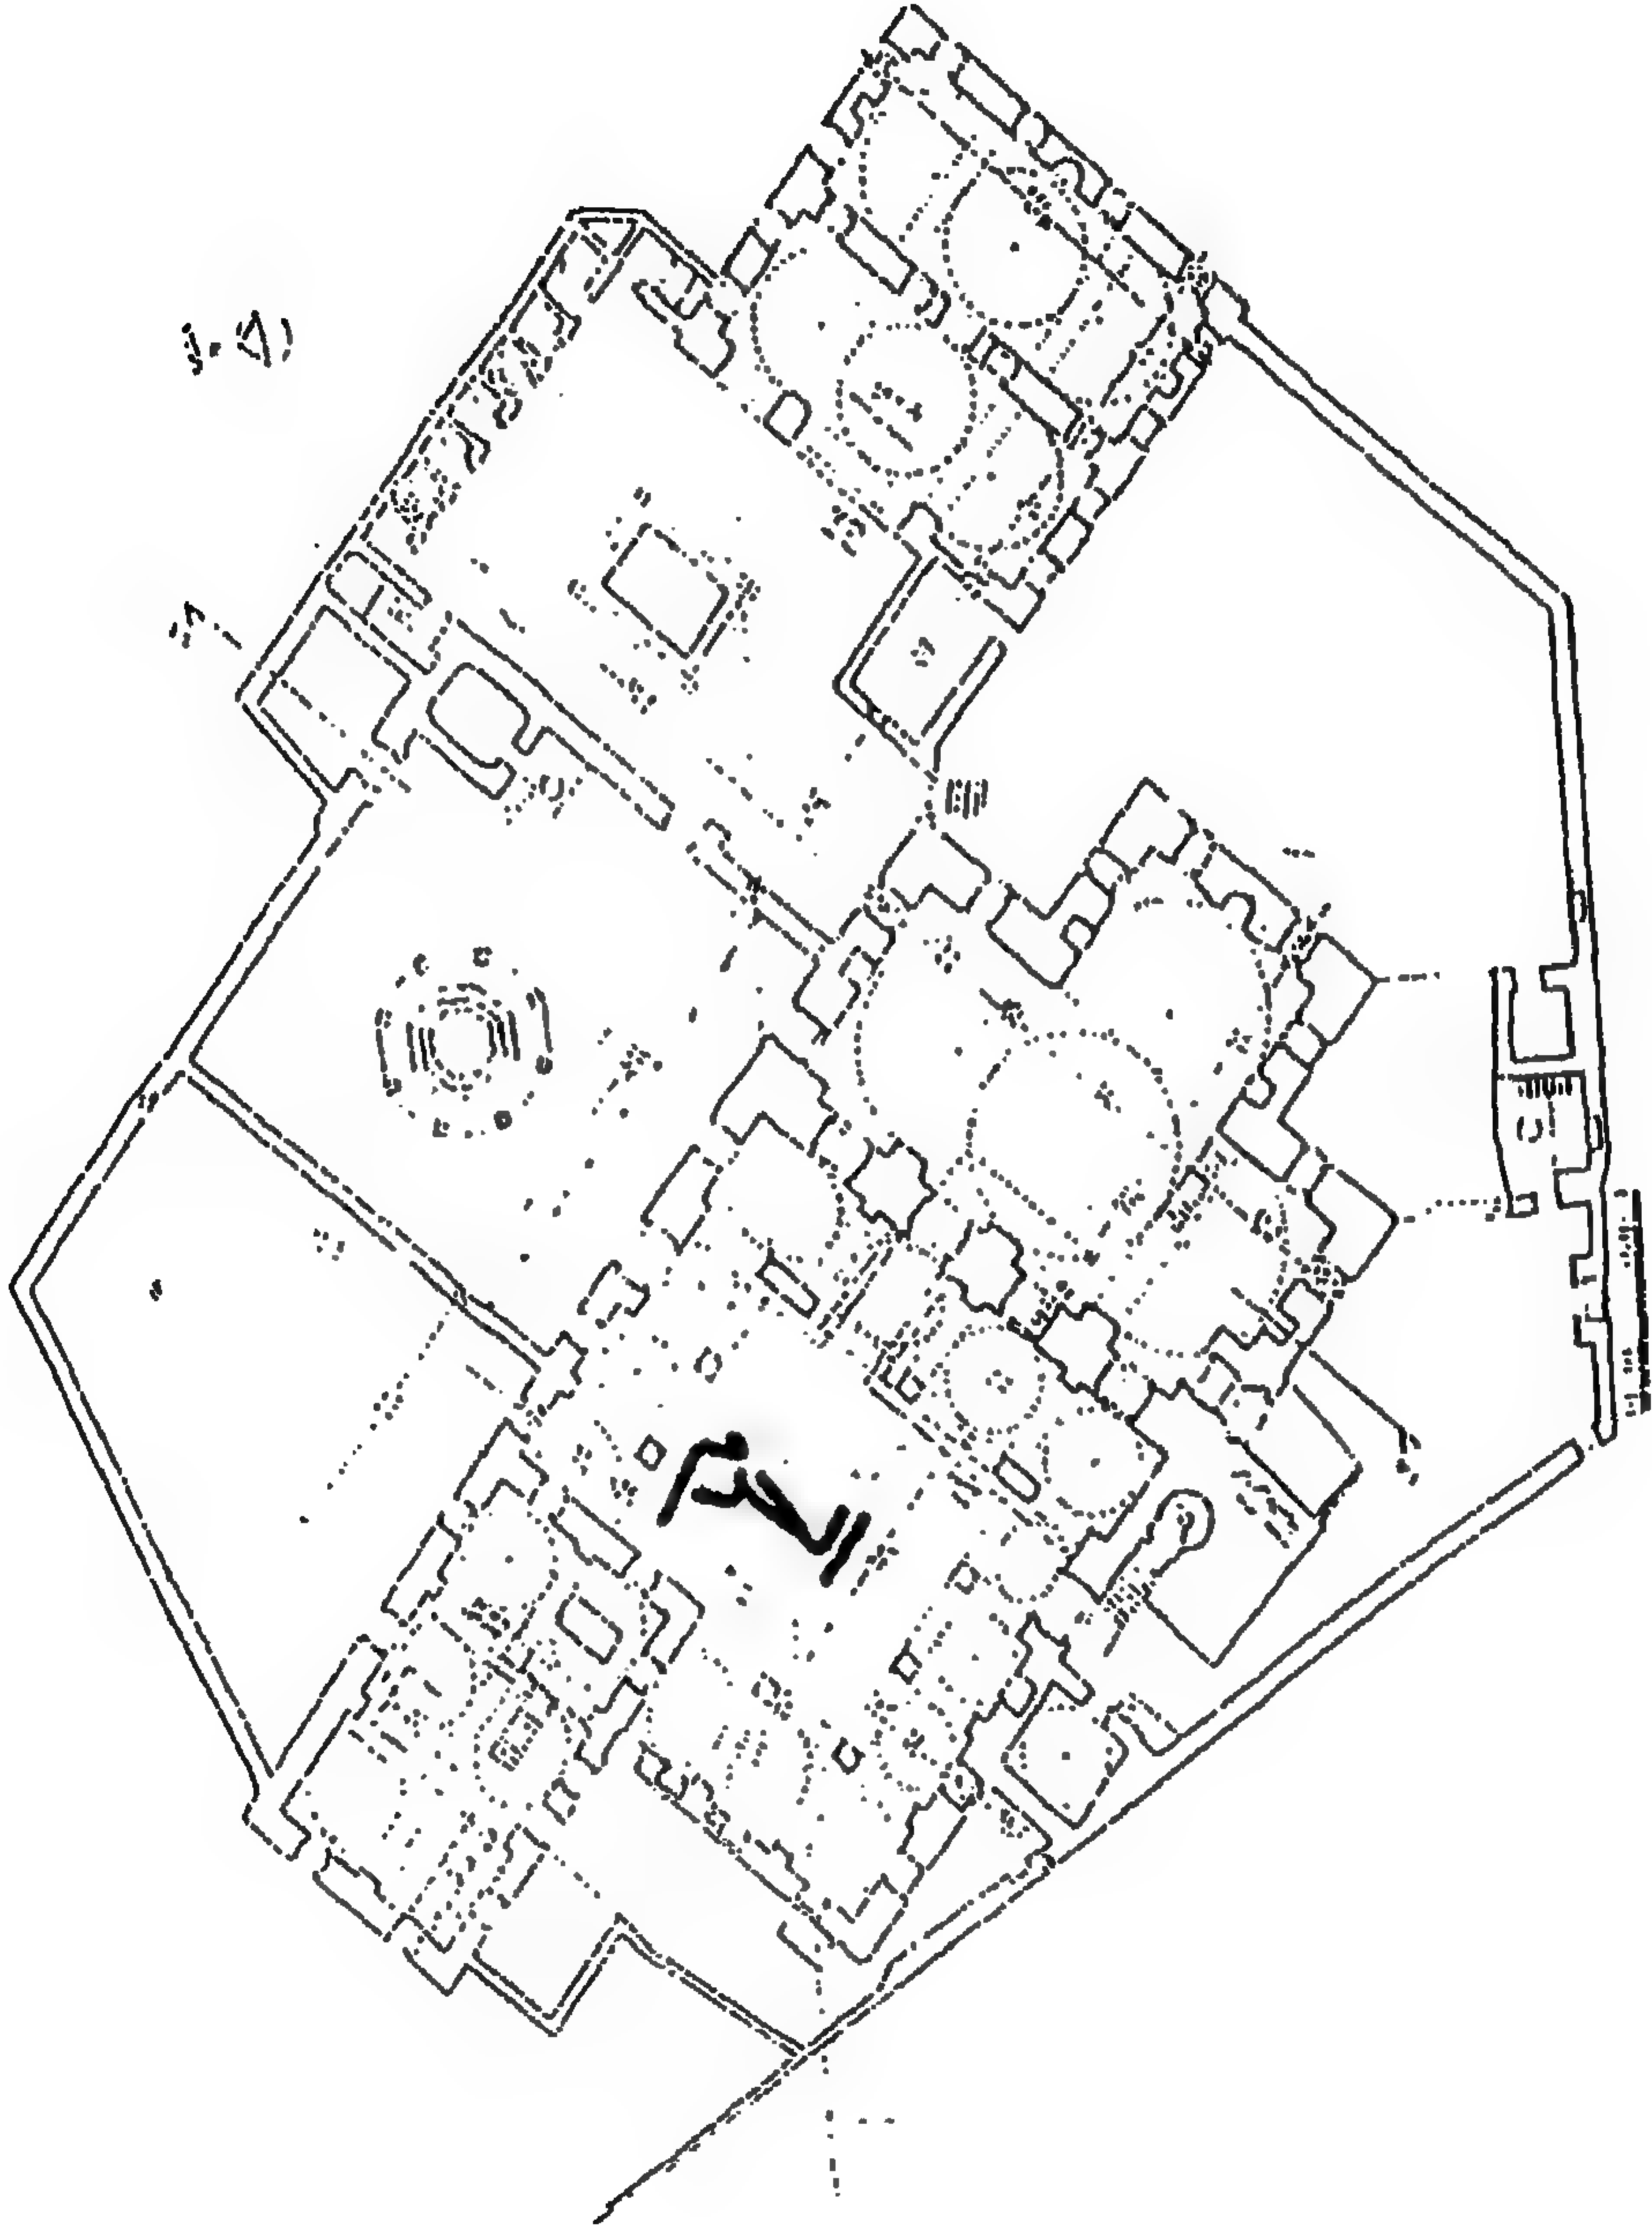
مسقط أفقي لجامع حسن بك في حابر أبولو (عن : Kuran)
